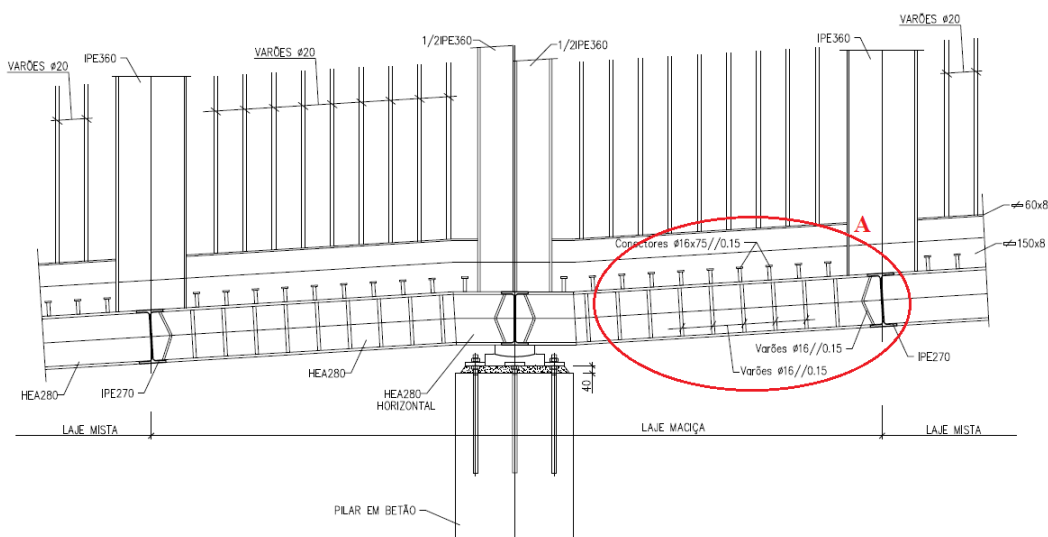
Corte longitudinal do tabuleiro na zona dos pilares [25].
